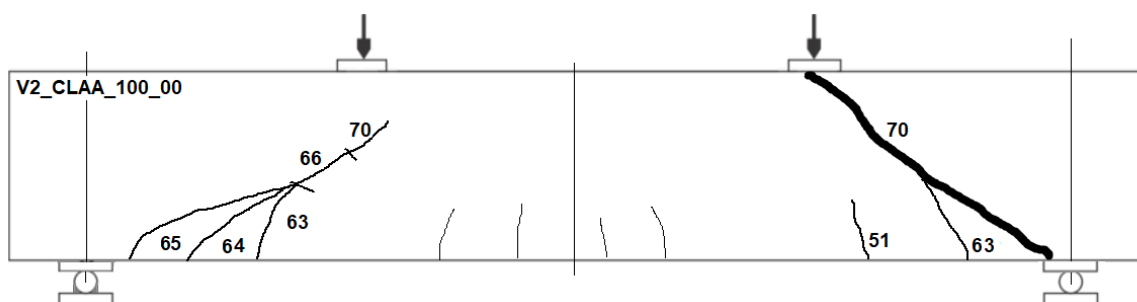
Esquema de fissuração da Viga 2_CLAA_100_00.
